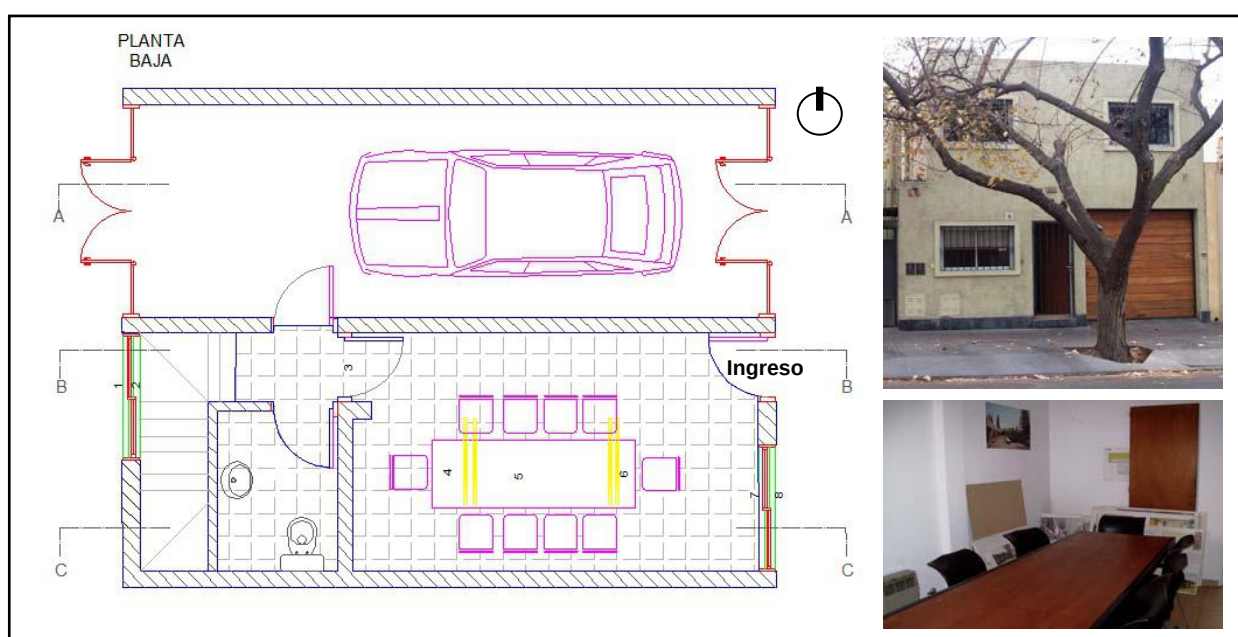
planta baja de la oficina y foto del frente y del interior de la sala de reuniones.
